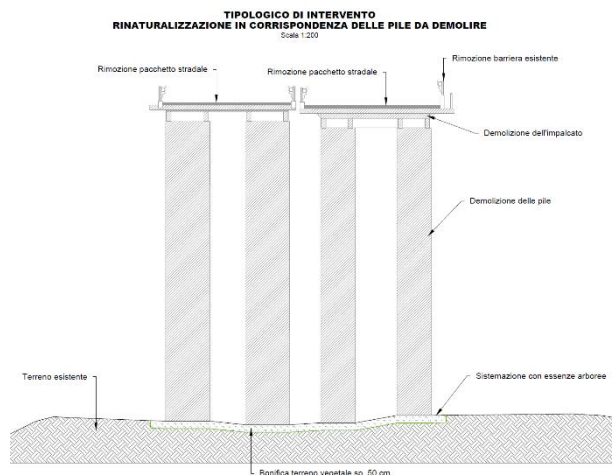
Sezione tipo rinaturalizzazione in corrispondenza delle pile da demolire
